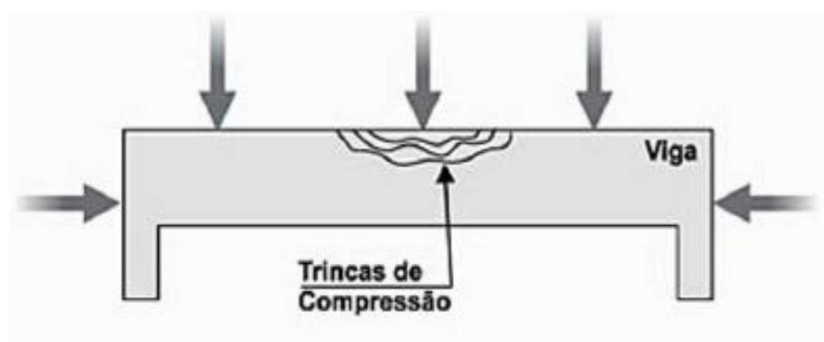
Fissuras por compressão (MARCELLI, 2007).
